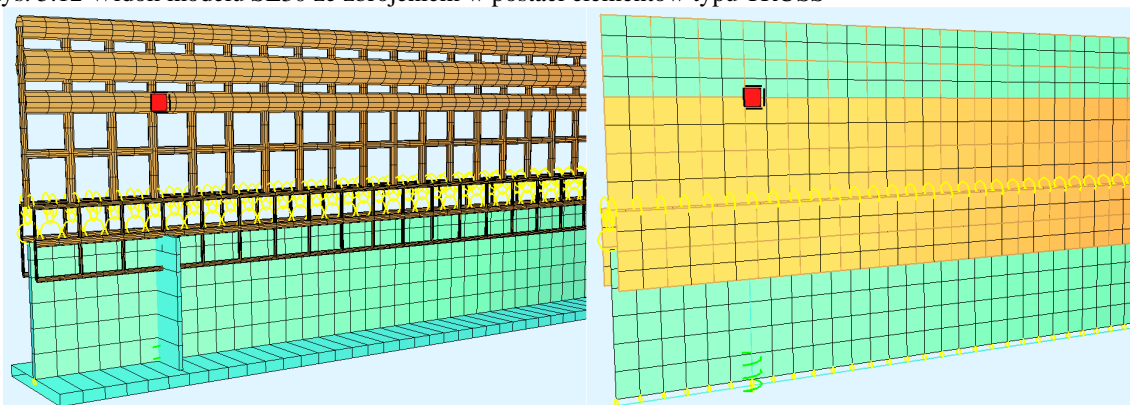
Widok modelu SL20 ze zbrojeniem w postaci elementów typu TRUSS
